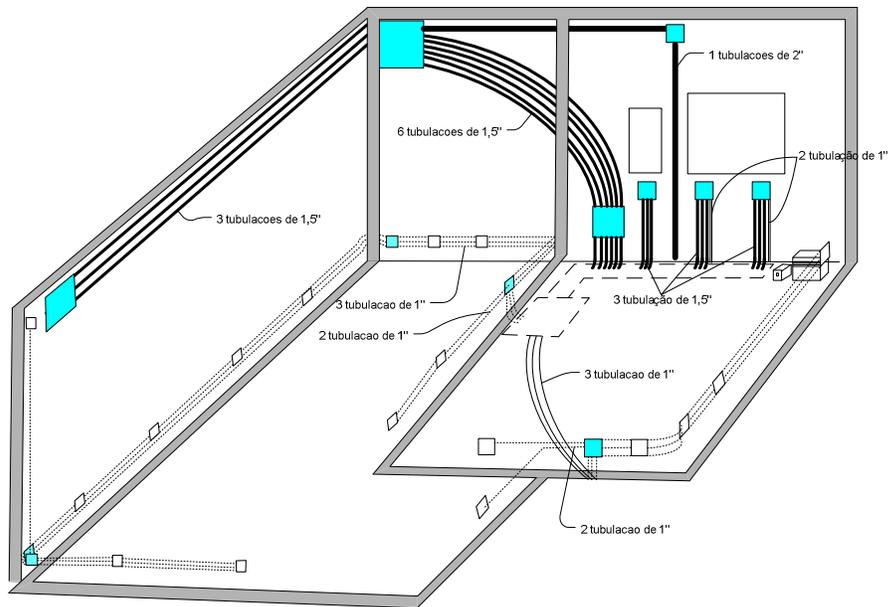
Infraestrutura da sala de equipamentos [Fonte do autor]
